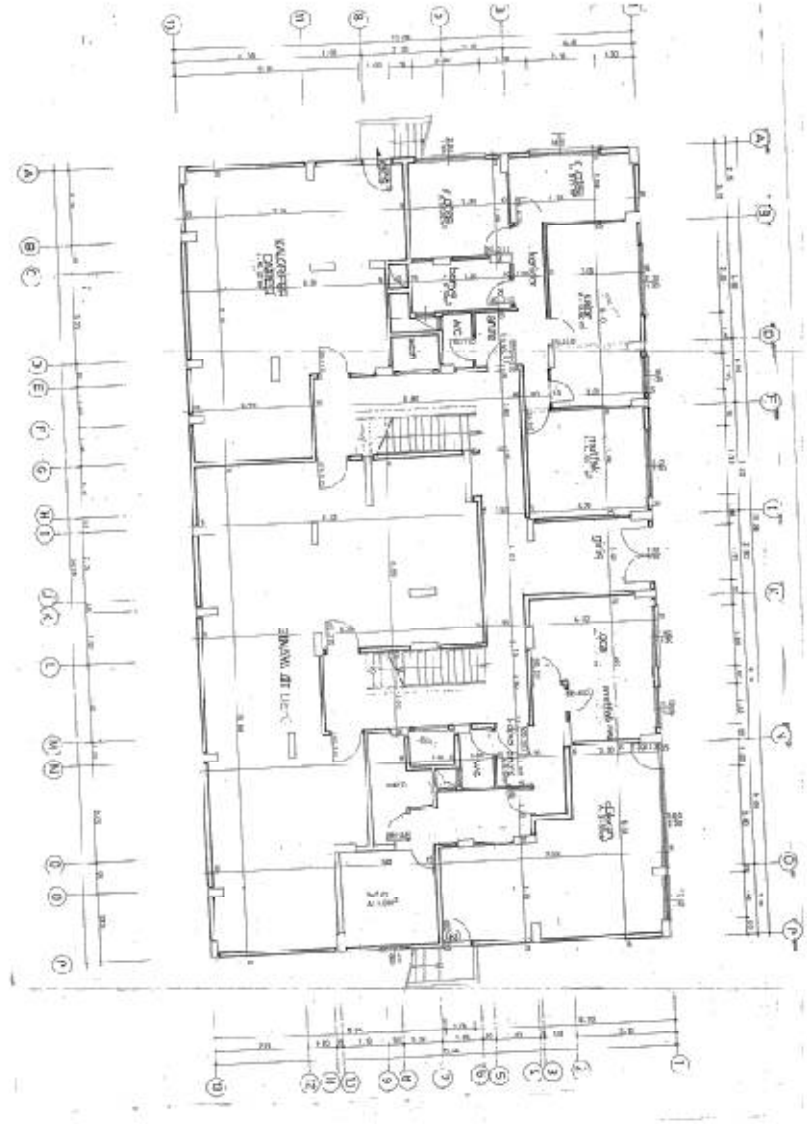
(9) Nolu bina temel aplikasyon planı
